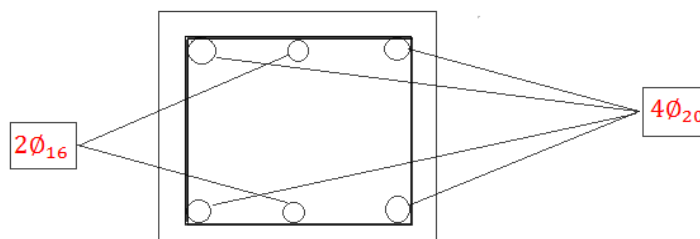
Ferrailage du poteau en traction selon le code BS
